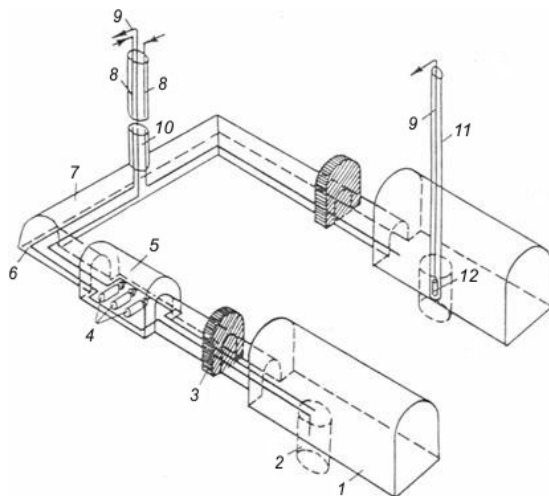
Схема подземного хранилища с погружными и непогружными насосами [150]:
